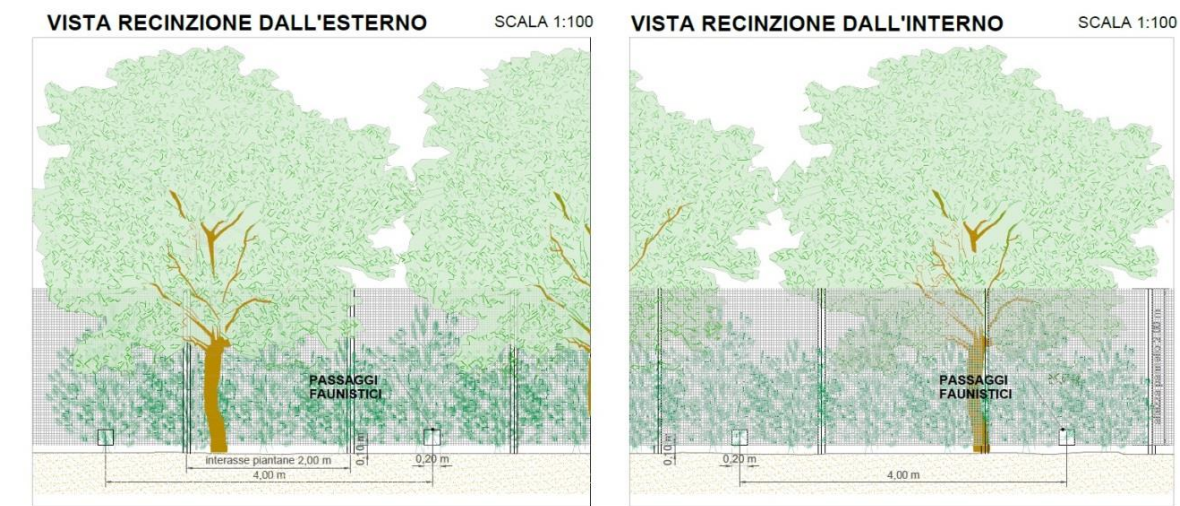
Prospetto recinzione perimetrale con mitigazione
